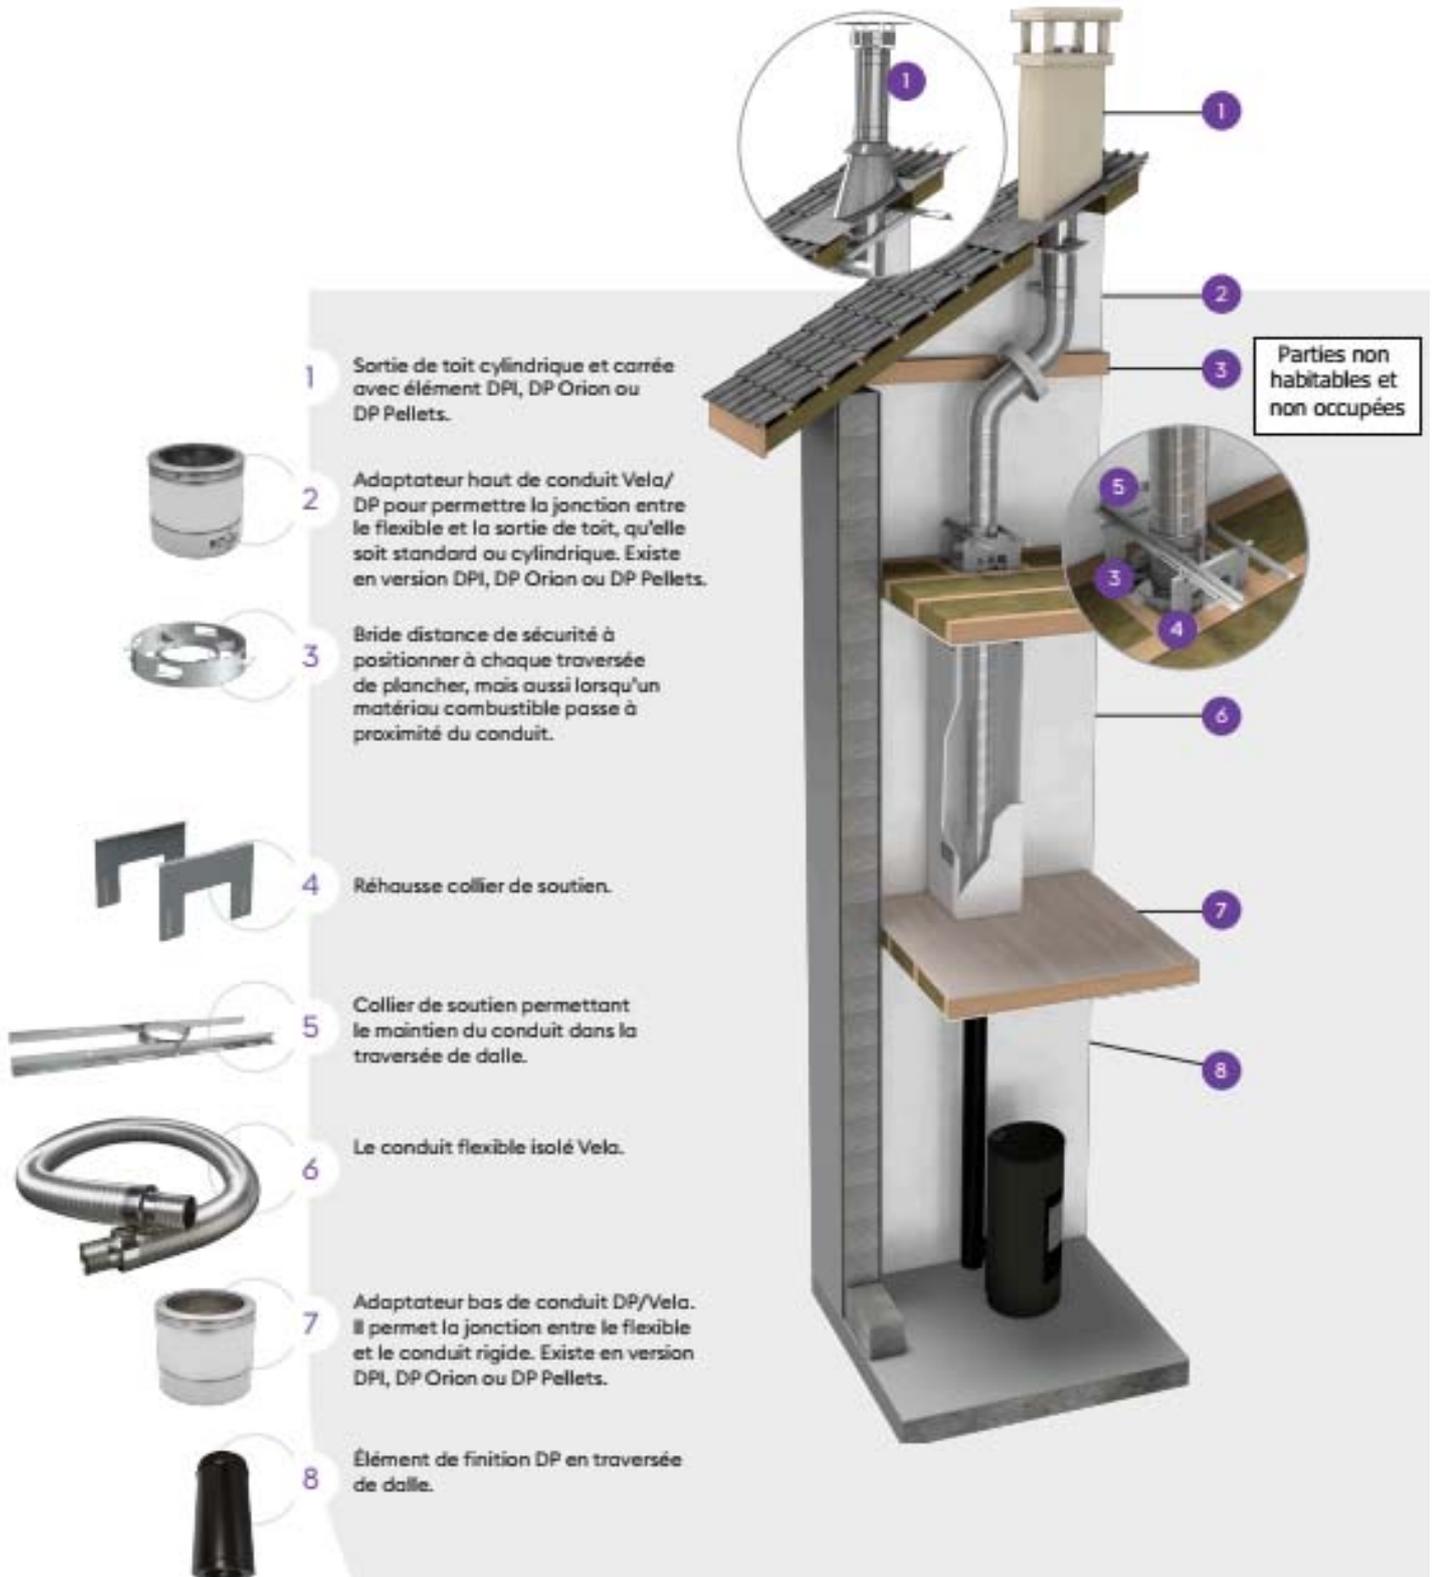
Mise en œuvre des adaptateurs haut et bas conduit double paroi/Conduit flexible VELA
